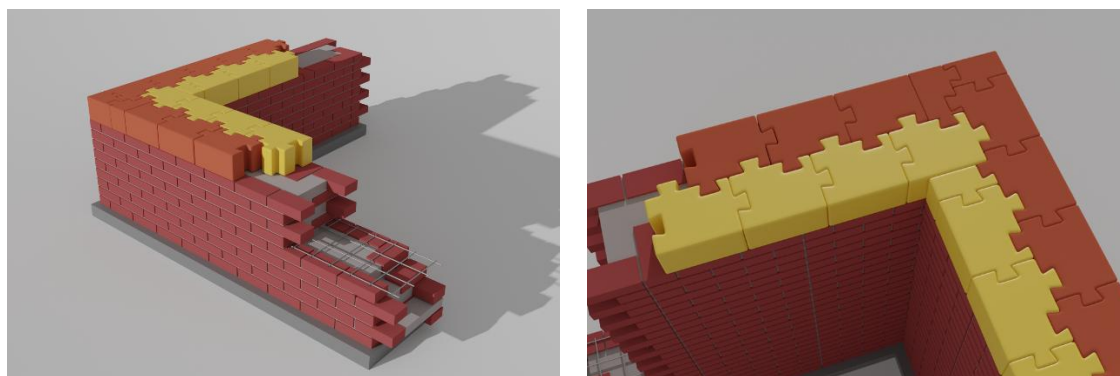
Фрагменты наружной стены с армирующим поясом
